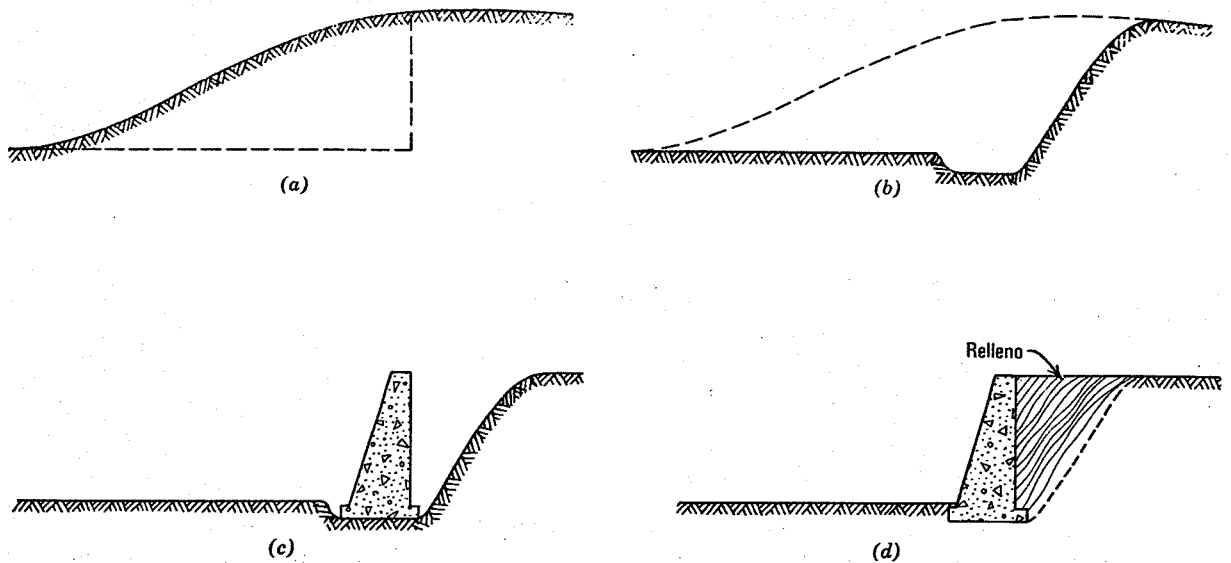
Fases de la construcción de un muro típico de gravedad. a) Excavación prevista. b) Excavación realizada. c) Construcción del muro. d) Vertido del relleno.
